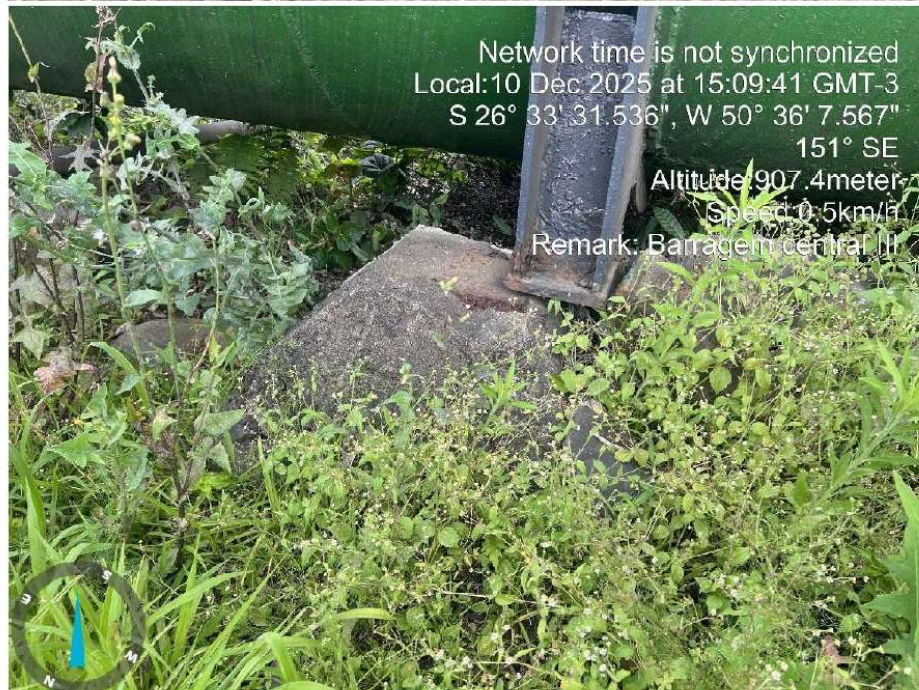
OXIDAÇÃO EM ESTAGIO AVANÇADO
